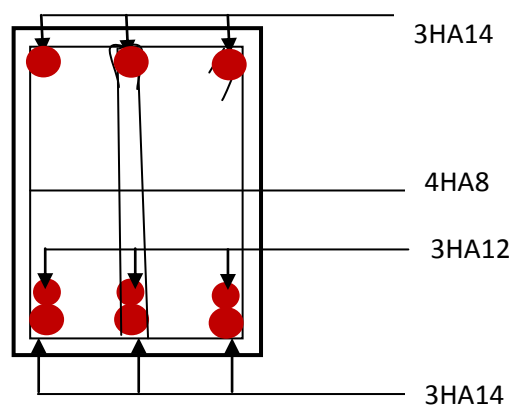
Ferrailage en travée d'une poutre principale
